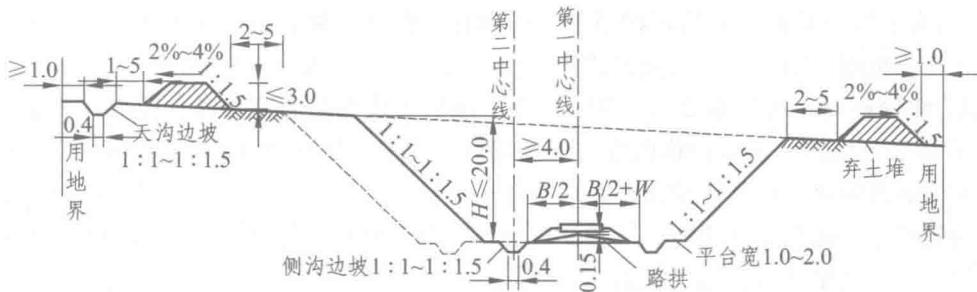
曲线地段一般黏性土路堑标准横断面图 (单位: m)
